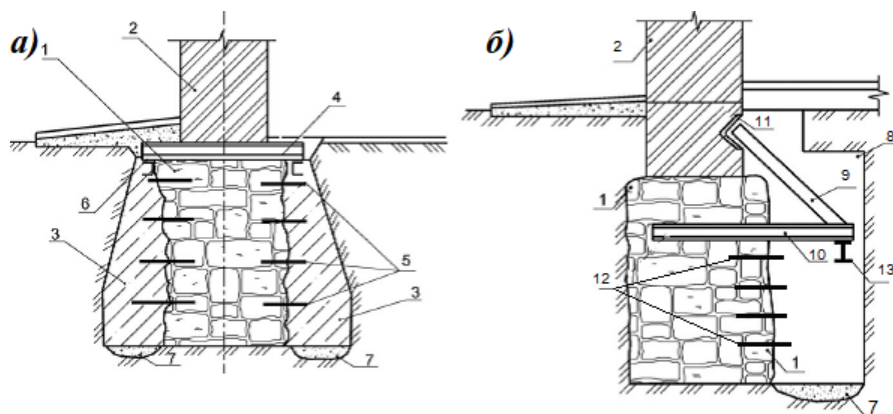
Увеличение несущей способности ленточного фундамента за счет уширения подошвы: а)бутового за счет устройства двухсторонних железобетонных или бетонных приливов; б) бутового за счет устройства одностороннего железобетонного или бетонного банкета; 1 – усиливаемый бутовый фундамент; 2- кирпичная стена; 3 – железобетонные или бетонные приливы; 4- металлическая балка, которая устанавливается в заранее устроенные отверстия; 5- металлические анкера; 6 – продольные металлические балки, скрепляемые на сварке с поперечными балками 4; 7- уплотненный грунт; 8- бетонный монолитный банкет; 9 – подкос; 10 – несущая балка, заделанная в бутовый фундамент; 11 – упорный уголок; 12- металлические анкера; 13- распределительная металлическая балка. [198]
